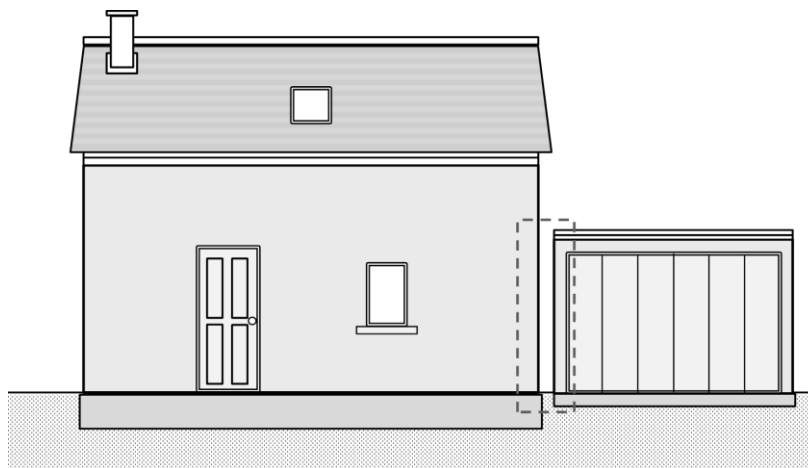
exemple de création d'un joint vertical d'affaissement d'un garage accolé à une maison individuelle
